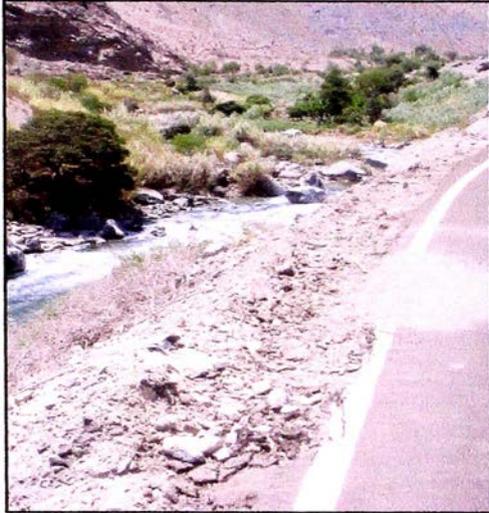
Fotografía de Inspección de Campo / Se observa los pronunciados taludes a lo largo de la vía hacia el río CAÑETE, donde el desprendimiento del material estabilizador nos alerta de posibles fallas que pueden causar al pavimento.
